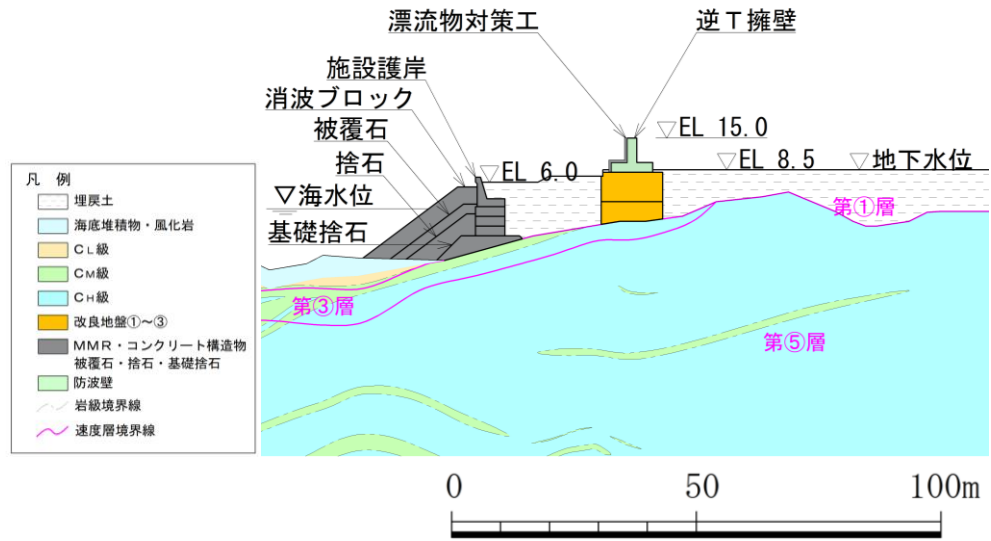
防波壁（逆 T 擁壁）の横断面図（②-②断面）
